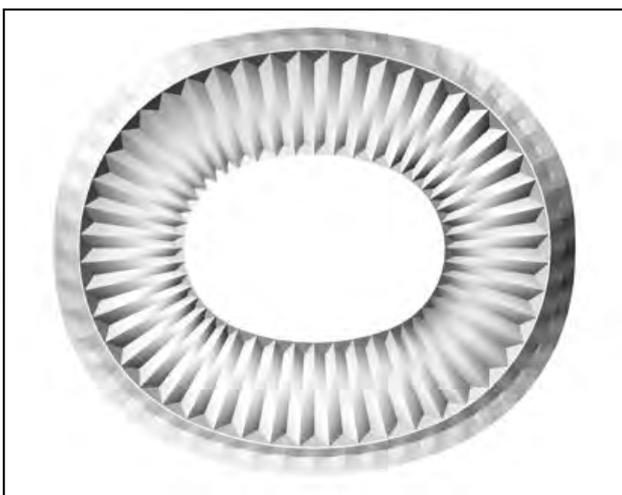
Visión aérea cubierta Wanda Metropolitano.
